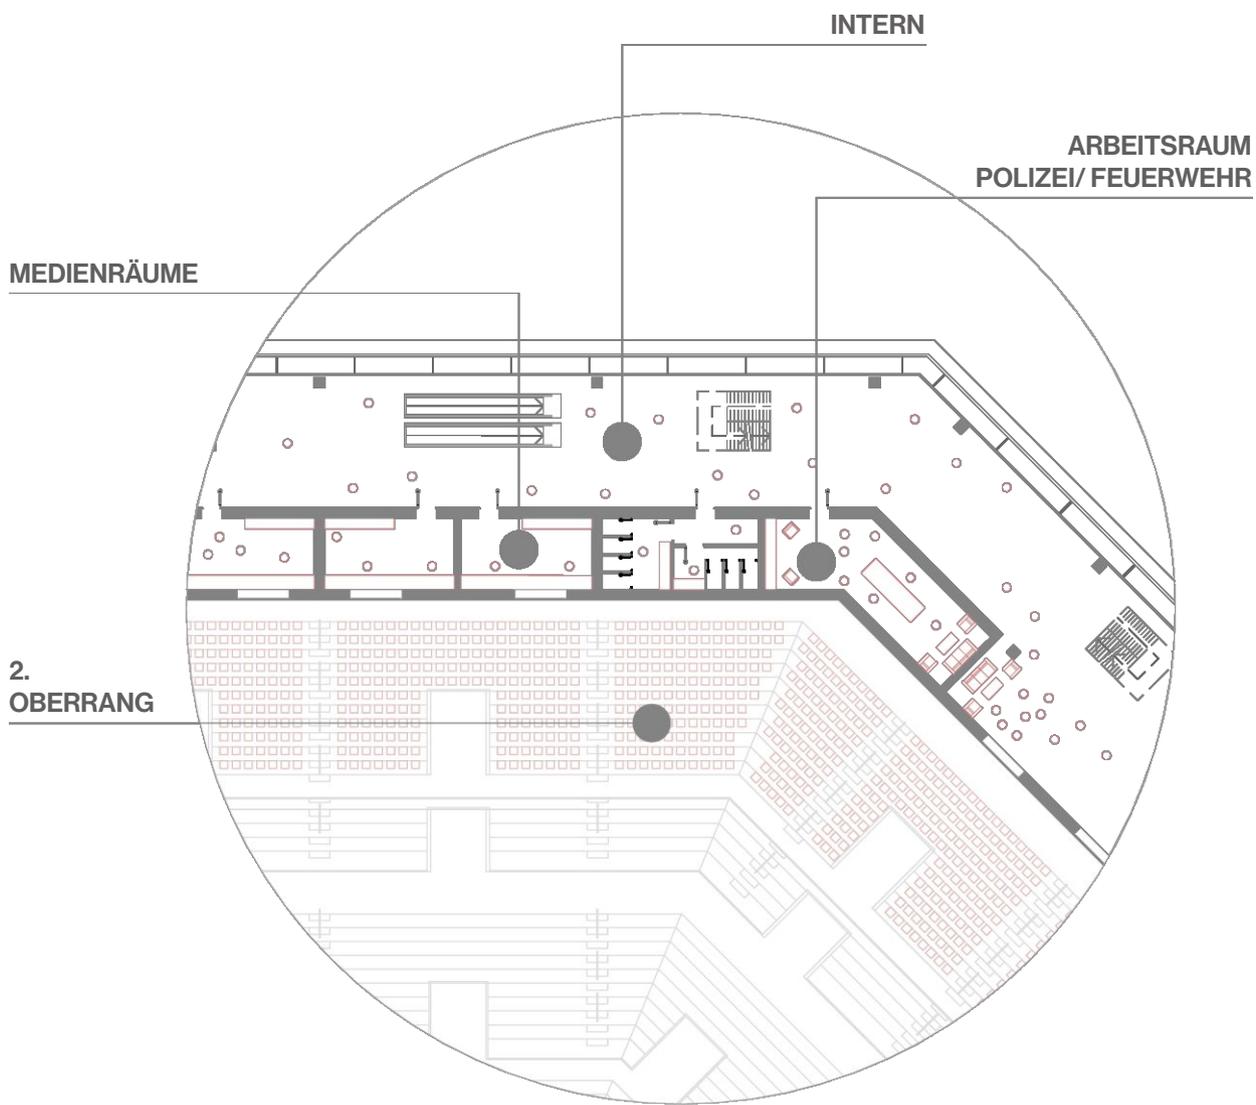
Grundriss 5. OG Nutzungsverteilung
